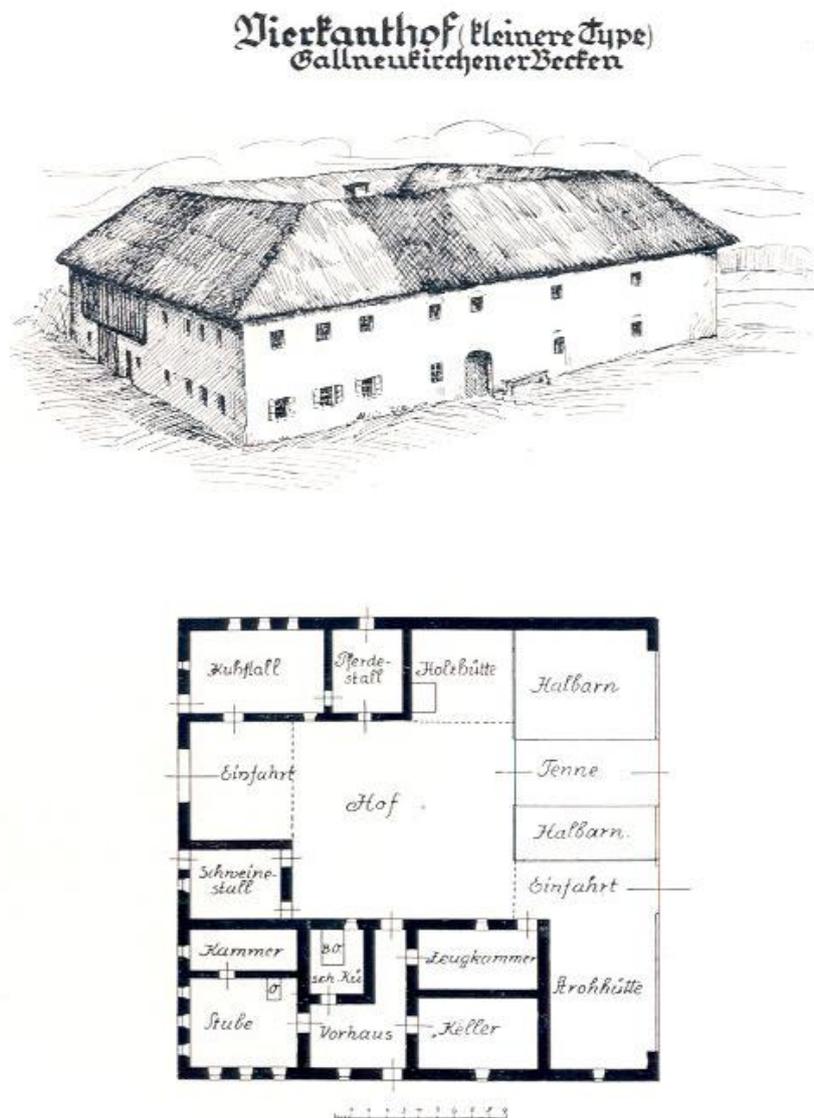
Aufriss und Grundriss eines Vierkanter (KRIECHBAUM 1933, Tafel I)
